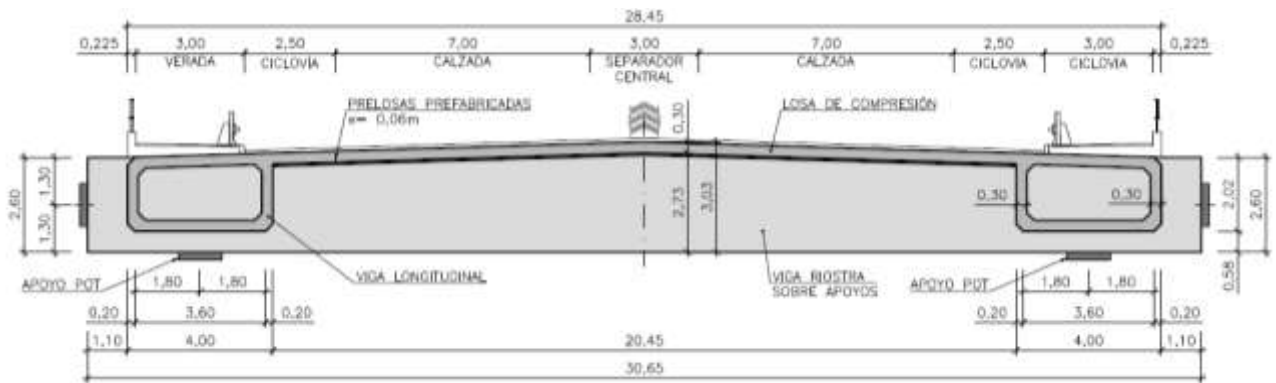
Secciones tipo del tablero por riostra sobre pilas.
